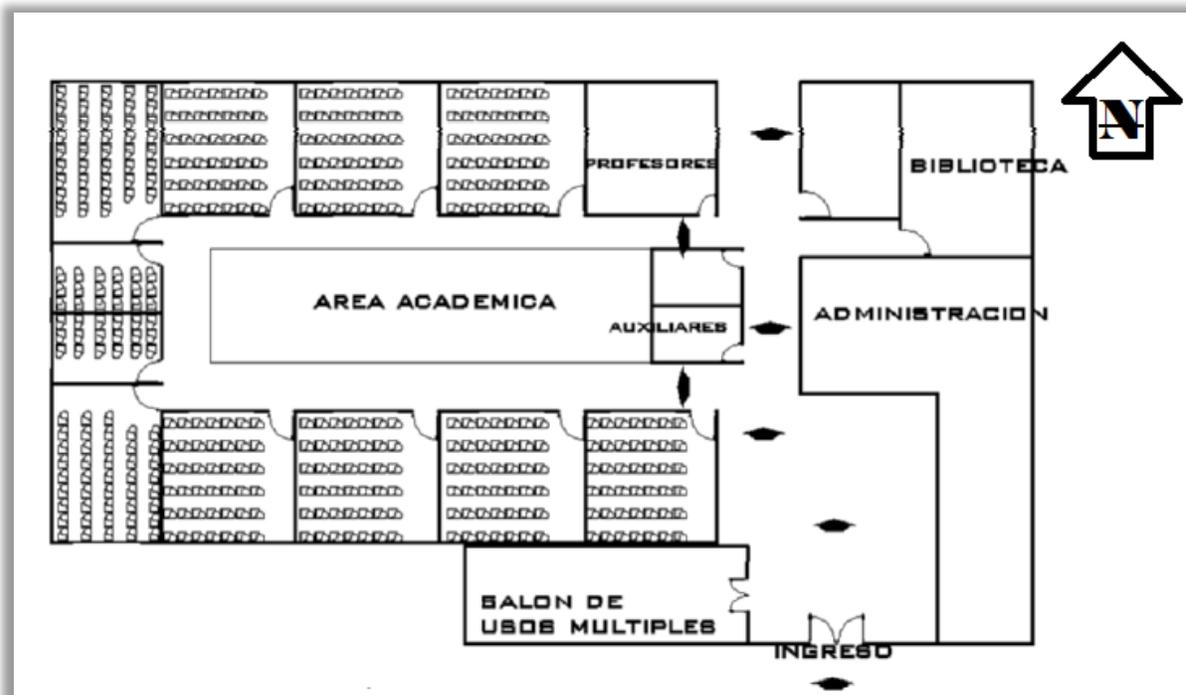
Planta de aulas académicas, Instituto Técnico Industrial. Fuente: Elaboración Propia.
